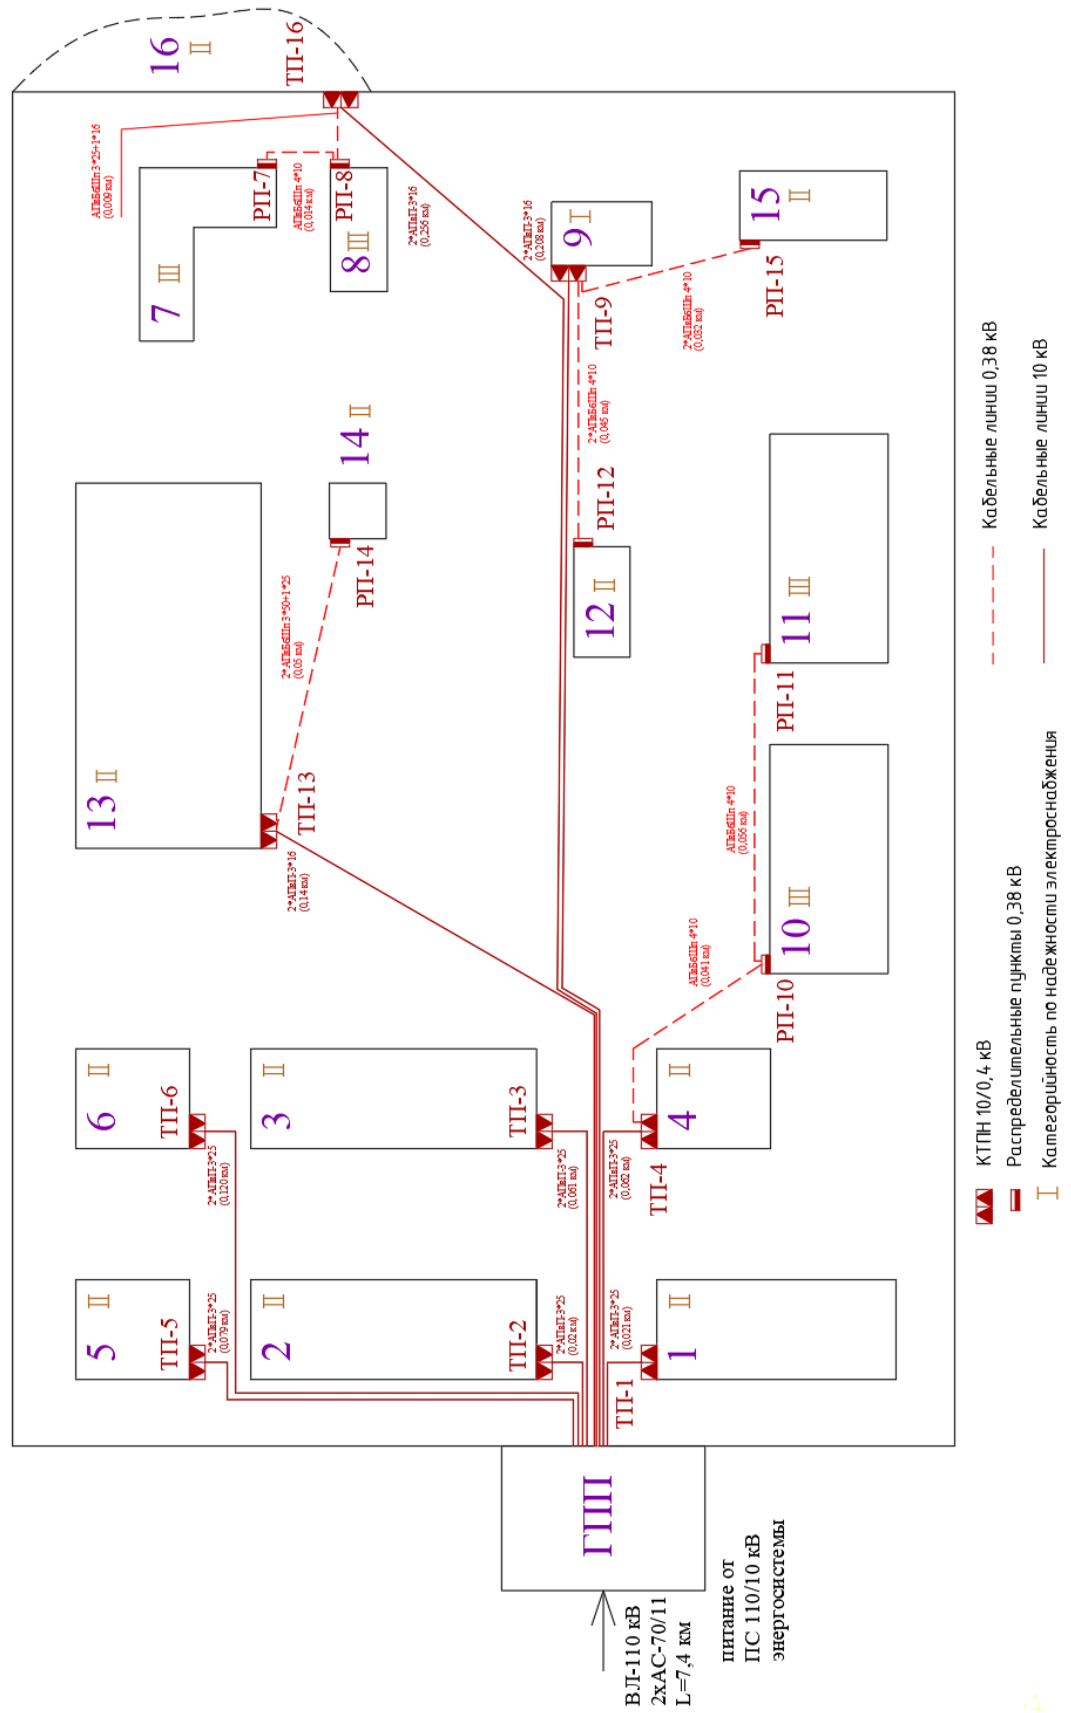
План прокладки кабельных линий после реконструкции
